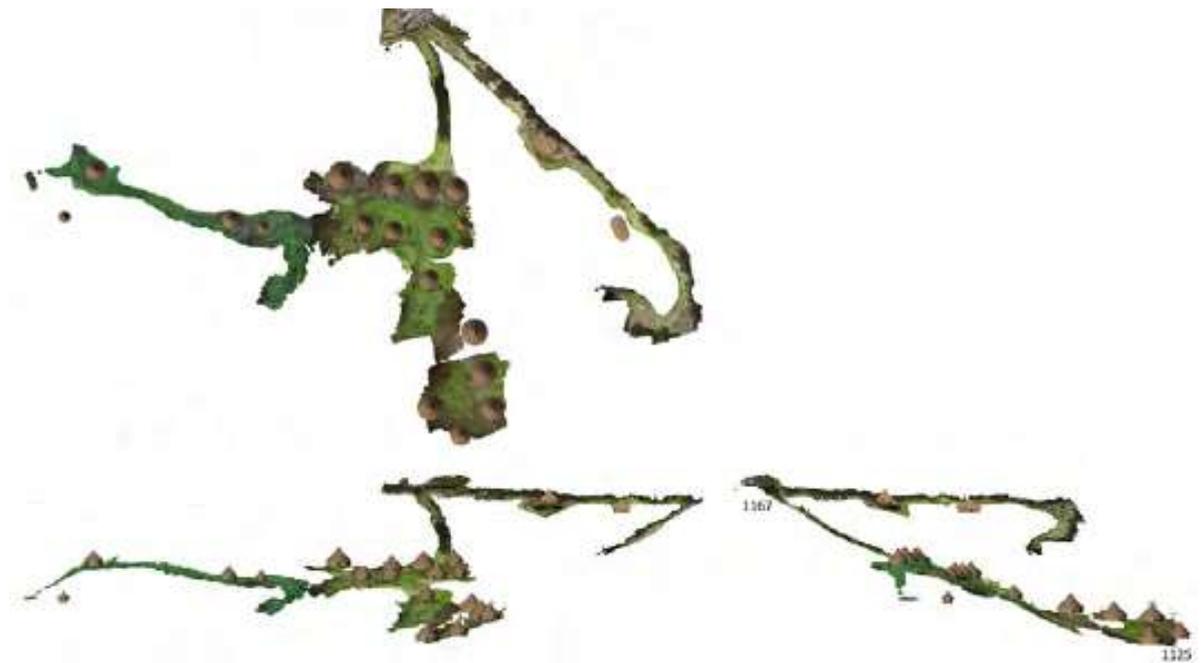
Sector Semidisperso, vista en planta, y alzado oeste y norte este último con los niveles. Elaboración propia, 2023.
